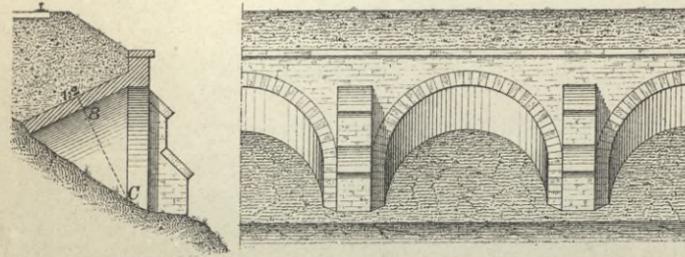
^c Stützmauer aus Eisenbeton zur Abgrenzung einer Wegerampe am Quai Debilly zu Paris. M. 1:33 1/3.
